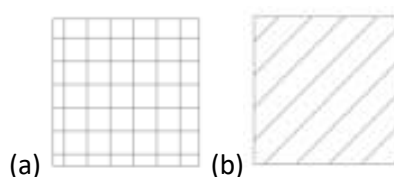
Padrão indicado: a) pavimentos; b) coberturas (Despacho n.º 6476-H/2021, 2021).
